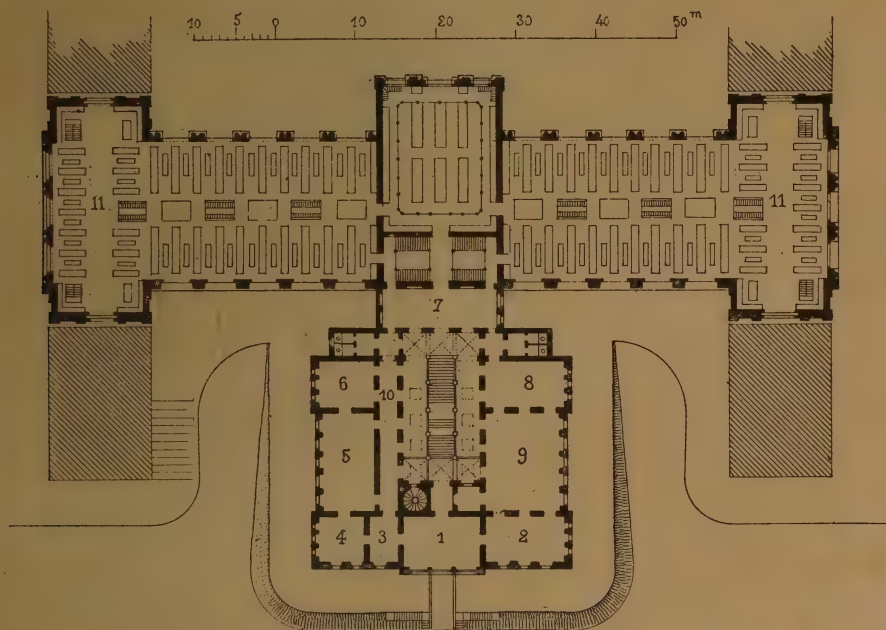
Plan de la bibliothèque de Stuttgart.
